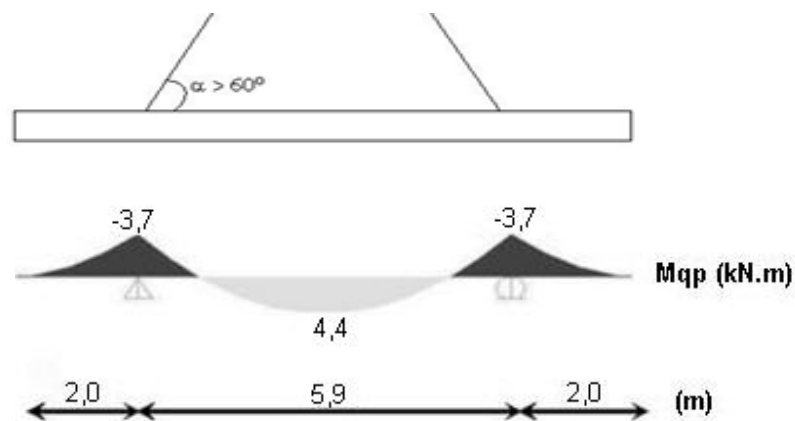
Elevação do 3º troço de pilar durante a fase construtiva
